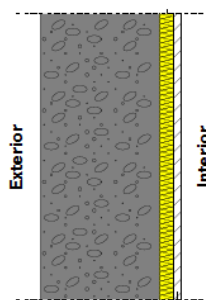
Pormenor das paredes exteriores – Par\_Ext\_5.
